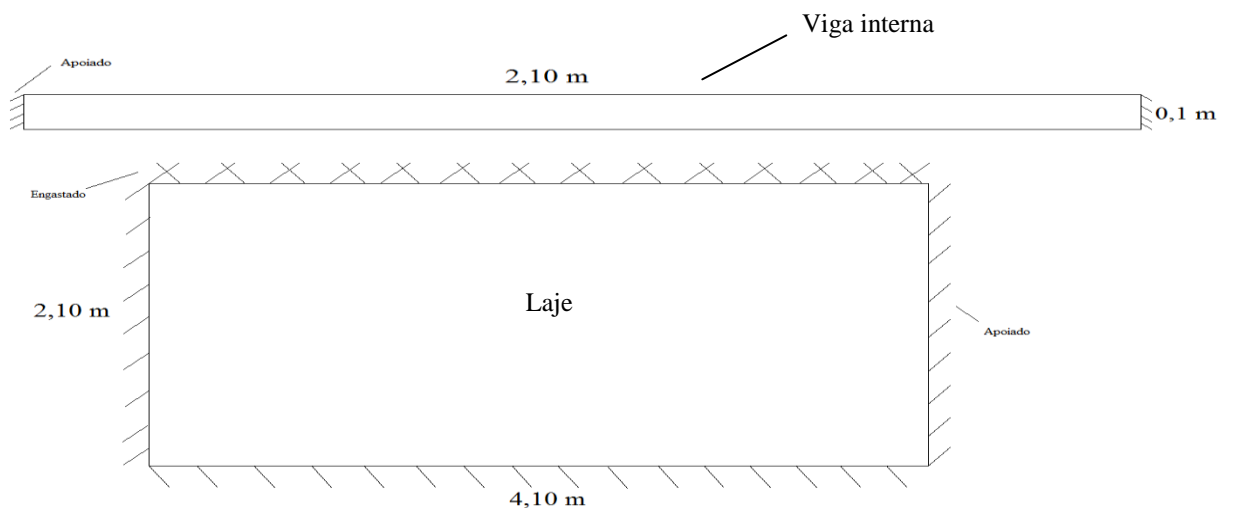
Viga interna e laje (ligada à V_1 , V_2 e V_3).
